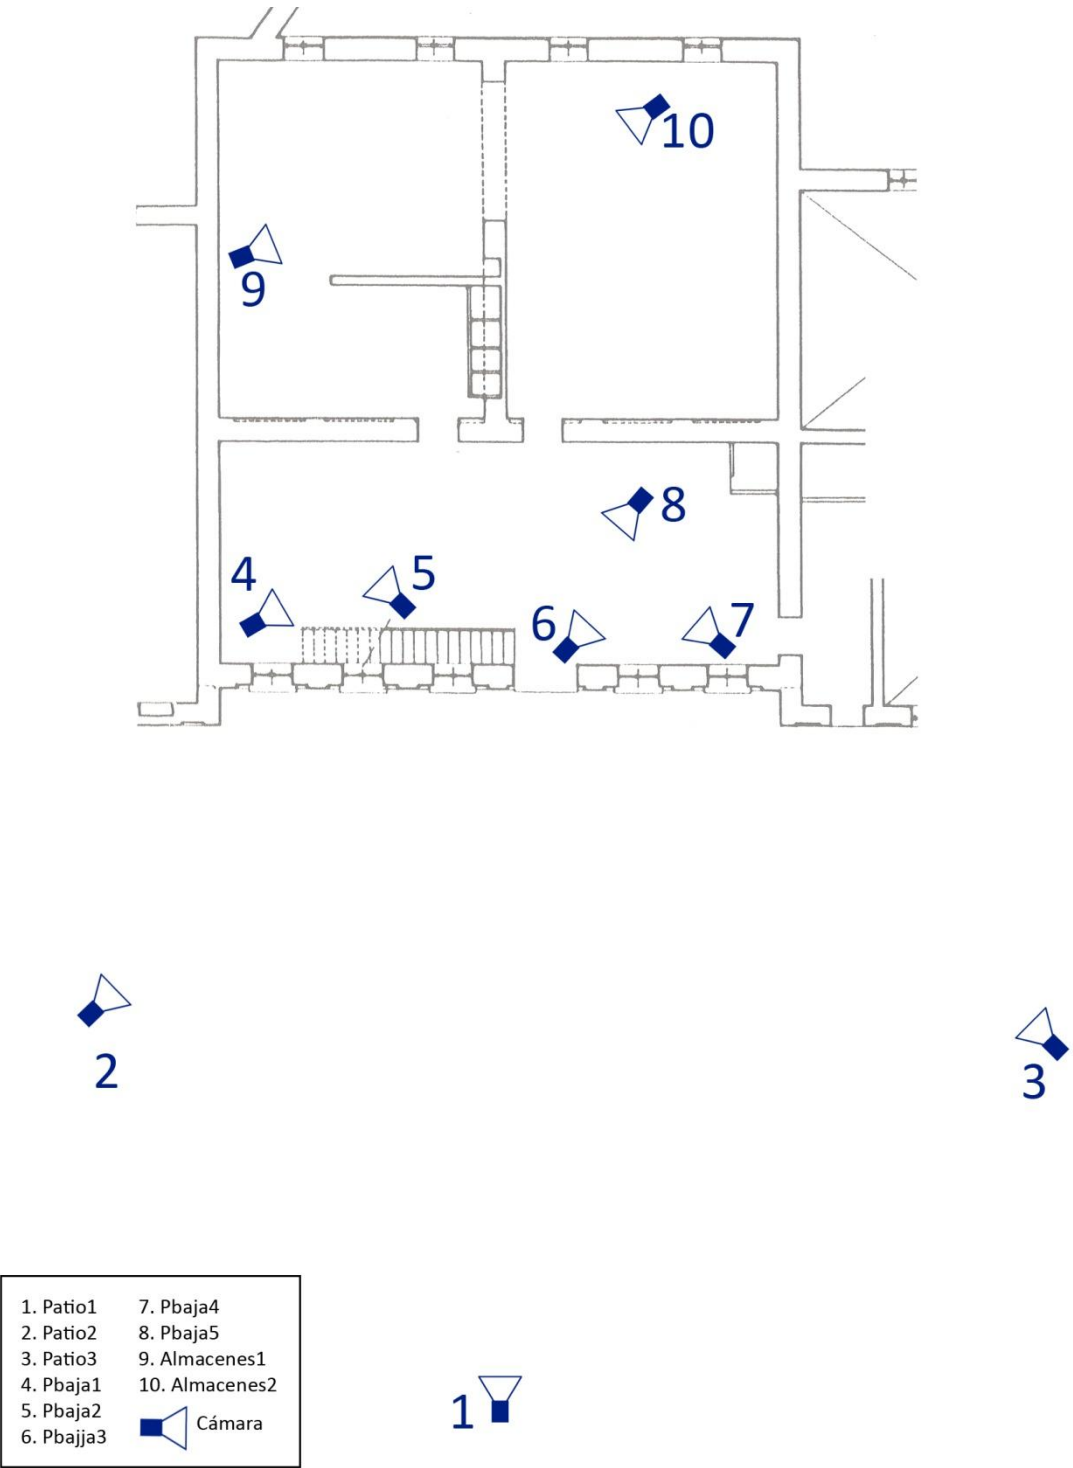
Distribución de cámaras en la planta baja, almacenes y patio.
